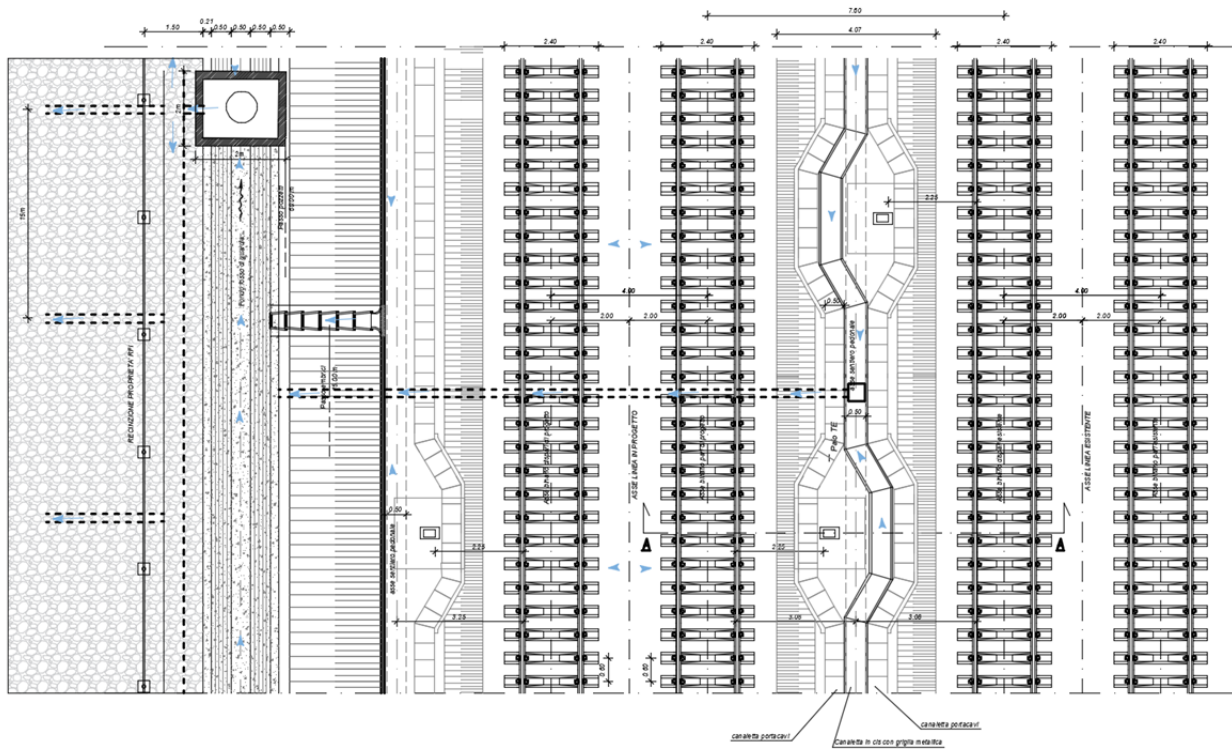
Sezione trincea drenante in corrispondenza del pozzetto di immissione
